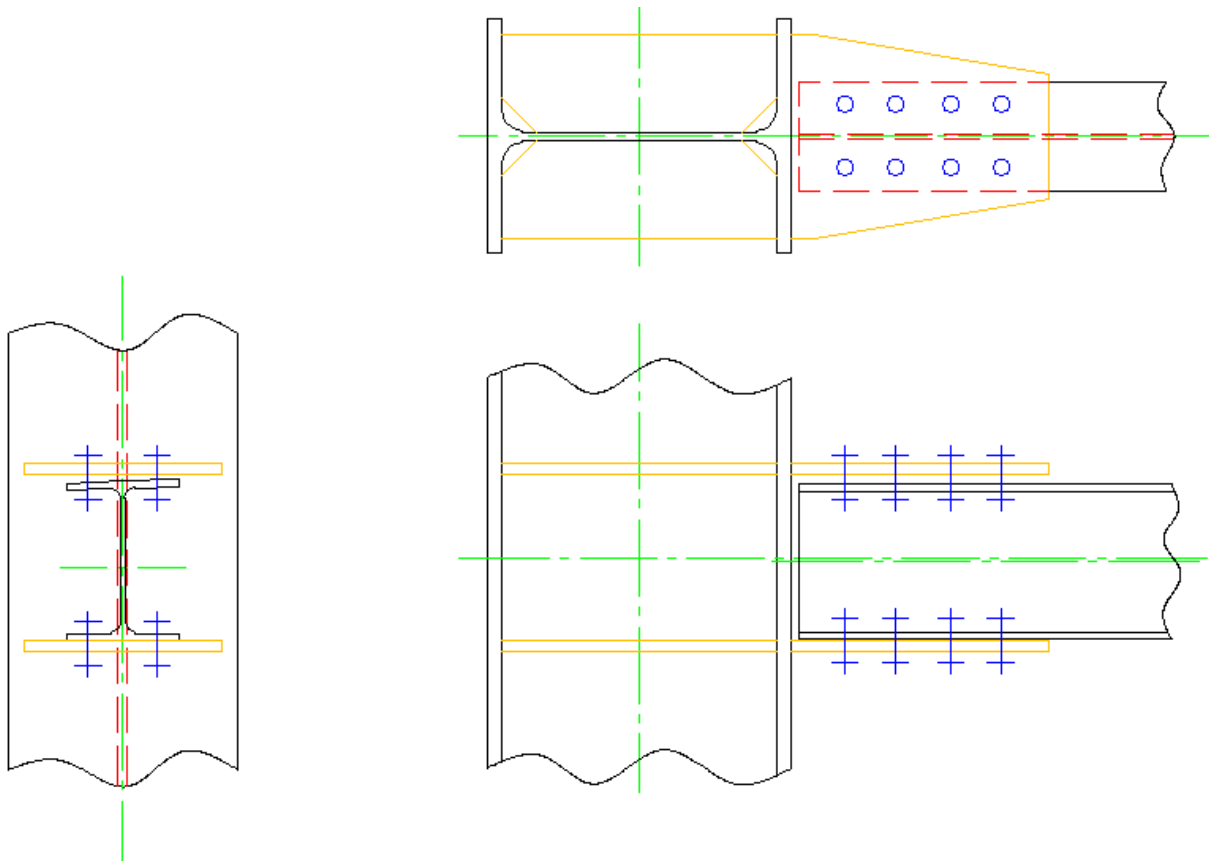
Beispielanschluss mit Walzprofilquerschnitten
